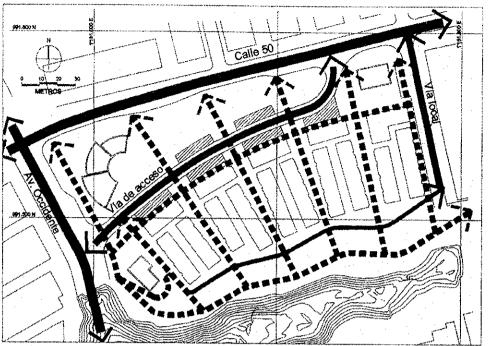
Malla vial. Figure 5.2.1. Road system Grid.
